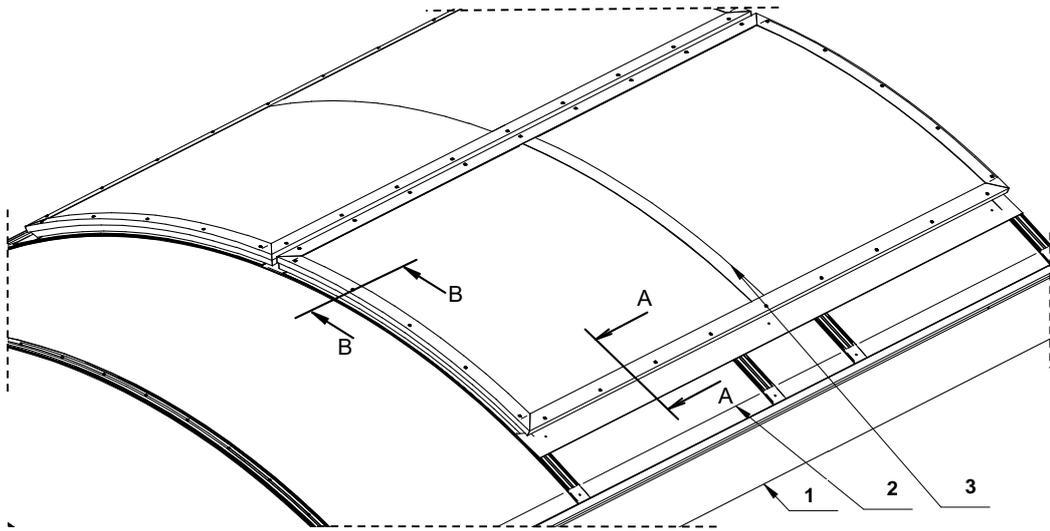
Eingebaute zweiflügelige Lichtbandklappe (geschlossen)
